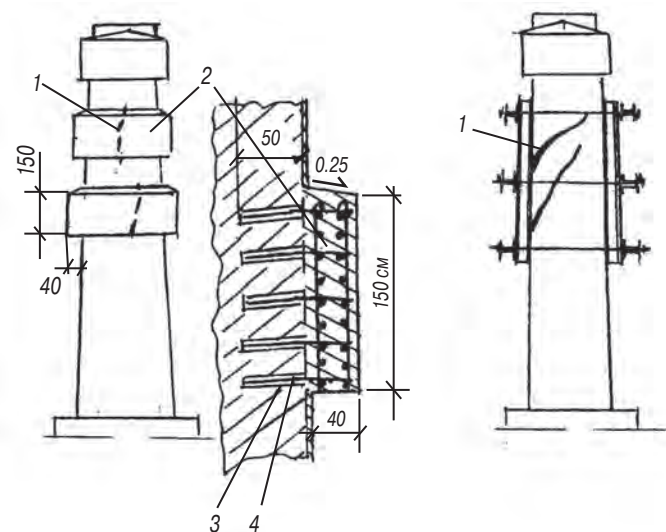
Железобетонные пояса и стальные бандажы опоры: а – пояс; б – бандаж; 1 – трещина; 2 – конструкция пояса; 3 – скважина; 4 – анкер
